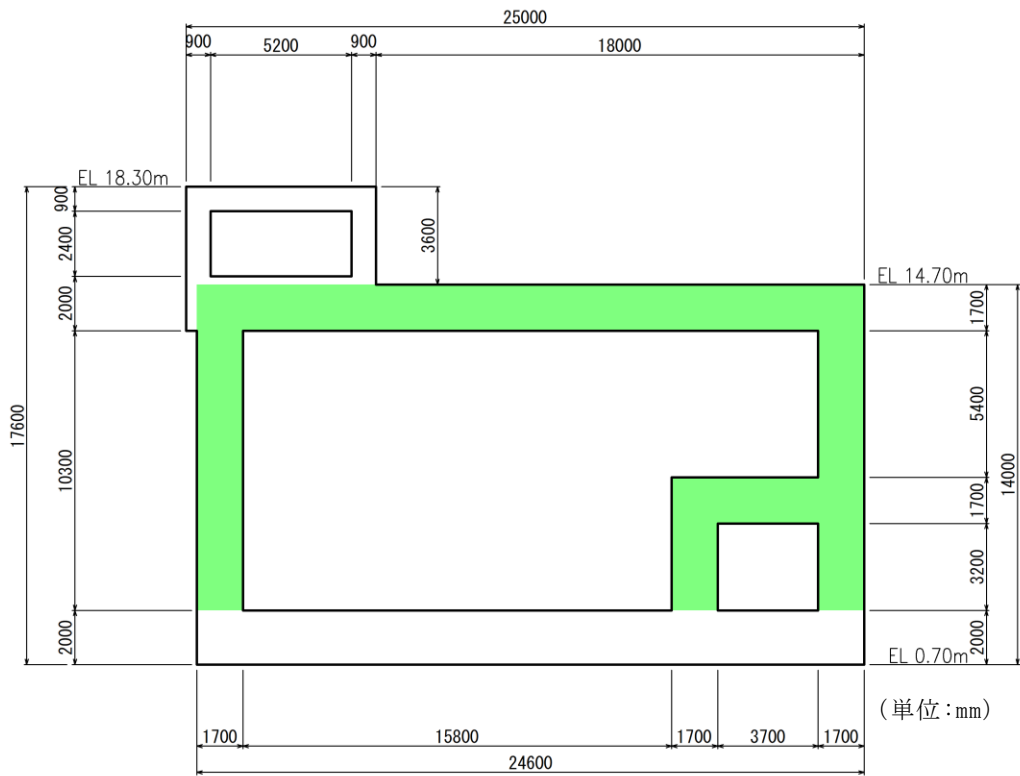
－18 第1 ベントフィルタ格納槽 断面図 (A－A断面)
